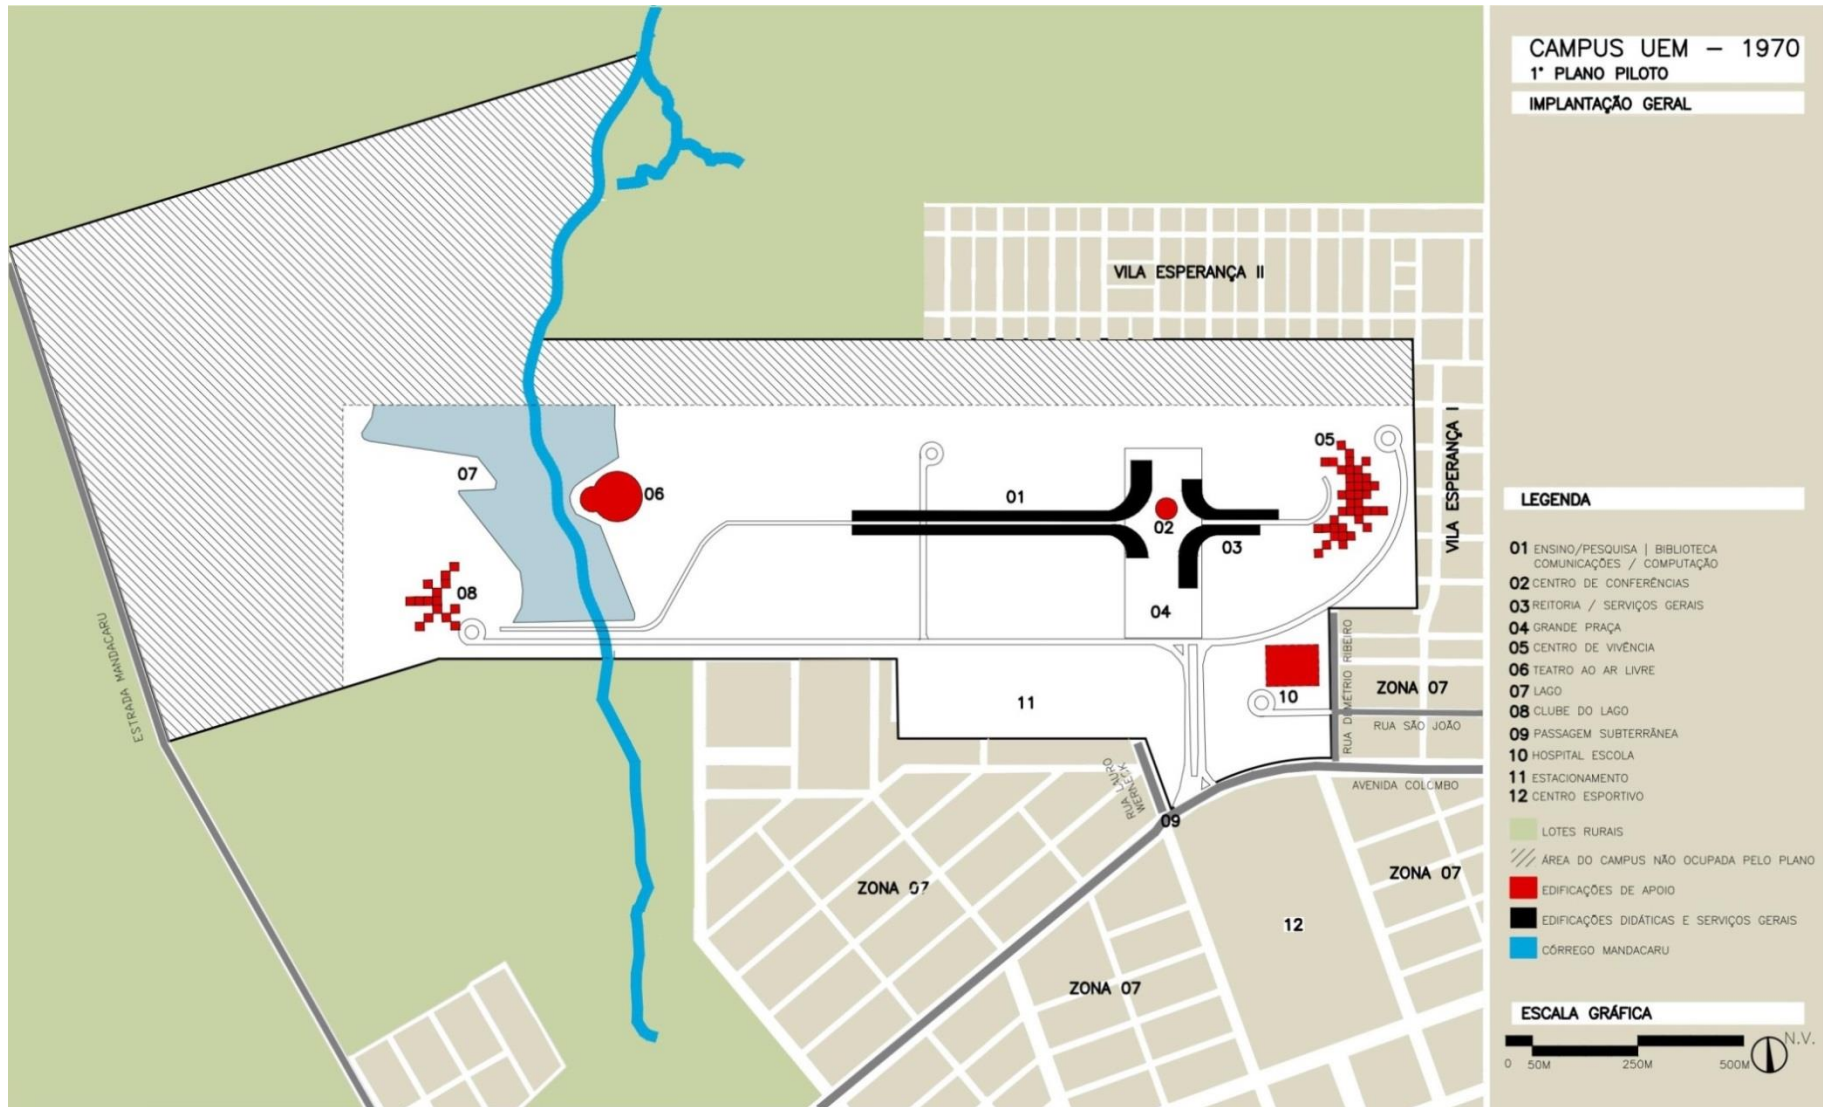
Implantação Geral Plano UMA. Fonte: Mapa Base - Pranchas 01 e 02 do Plano de Implantação Imediata – 1º Sub-Etapa Plano UMA . Arquivo digital disponível no COMCAP-UEM. Desenho: Renan Avanci.
